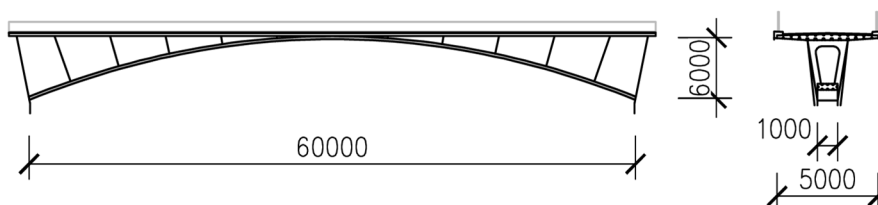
Konstrukce tvořená betonovou mostovkou a širokým betonovým obloukem
